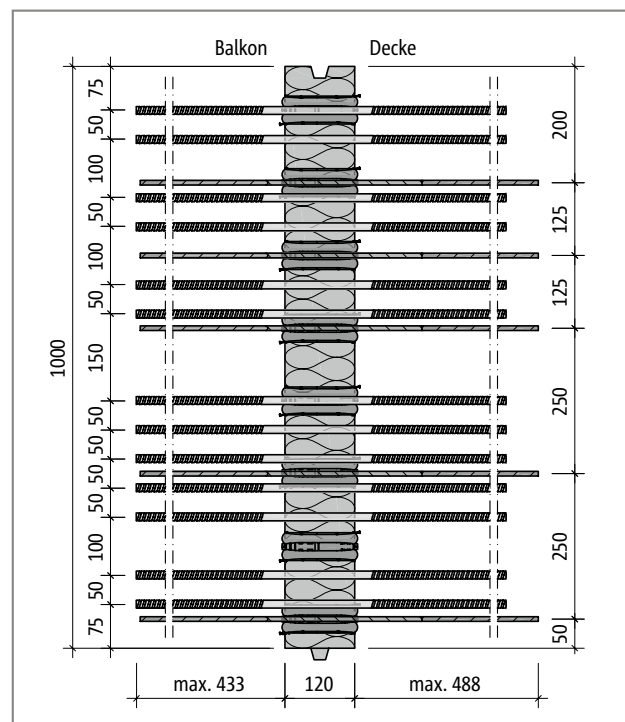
Schöck Isokorb® CXT Typ K-M6-V2: Produktgrundriss
